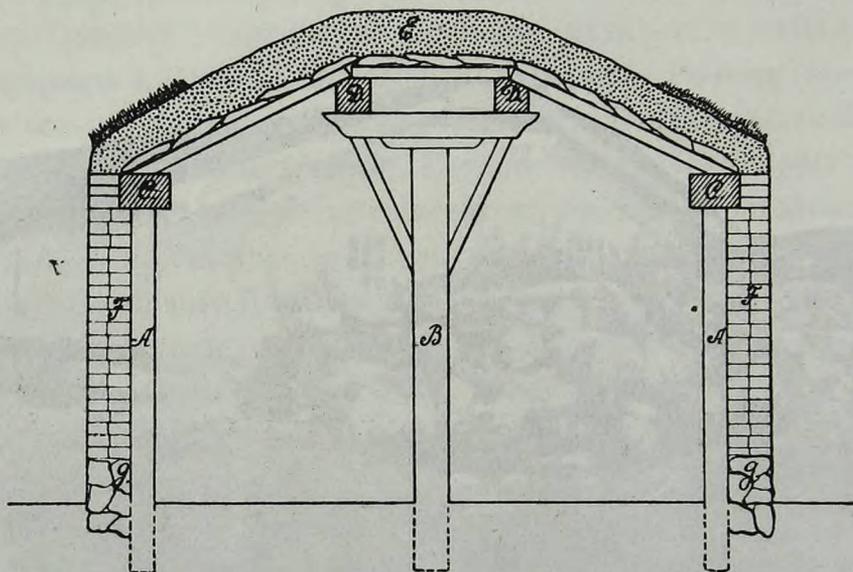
а. Конструкция жилищ духоборов в с. Гореловке. А—столбы, образ. основу стен. Е—земляная крыша. В—средний опорный столб. F—стены из кизячных кирпичей. С, D—продольные балки. g—каменный фундамент.
